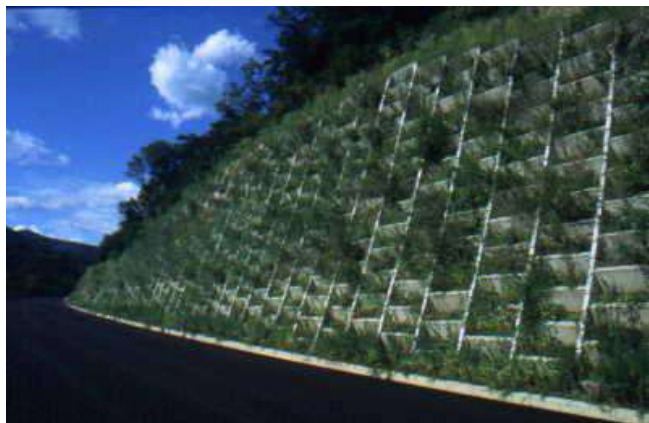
Muro a nicchie cellulari in terra armata con piantagione di arbusti (Autostrada dei Trafori – Foto G. Sauli 1990)
